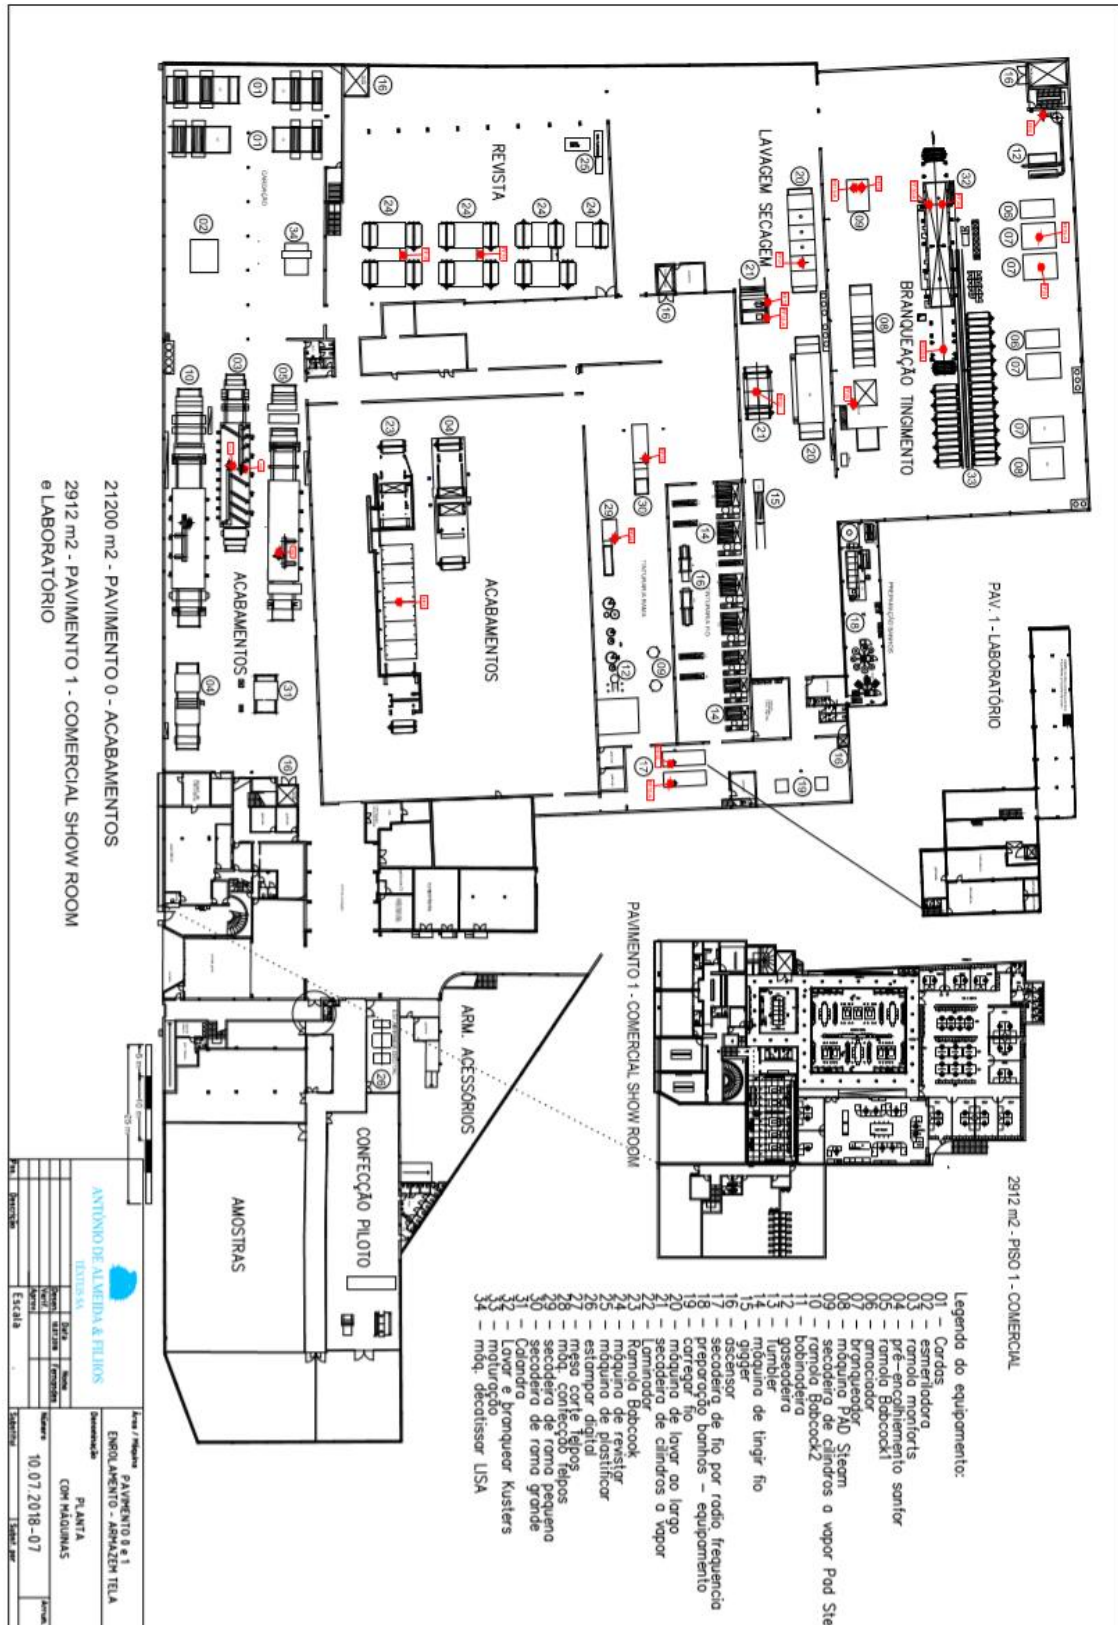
Layout das fontes de emissões gasosas do Pavimento -1.
